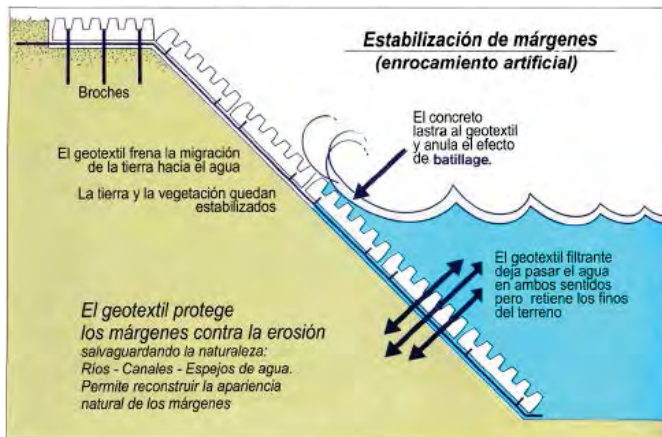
DETALLES CONSTRUCTIVOS para la utilización de las piezas de concreto prefabricado “Evergreen” en bordos de ríos, estanques y lagunas - Ref. Catálogo publicitario SOTUBEMA
